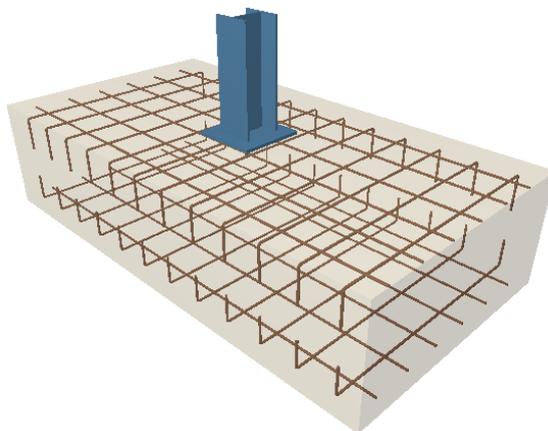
Zapata Z5. Fuente: CYPE 2017
